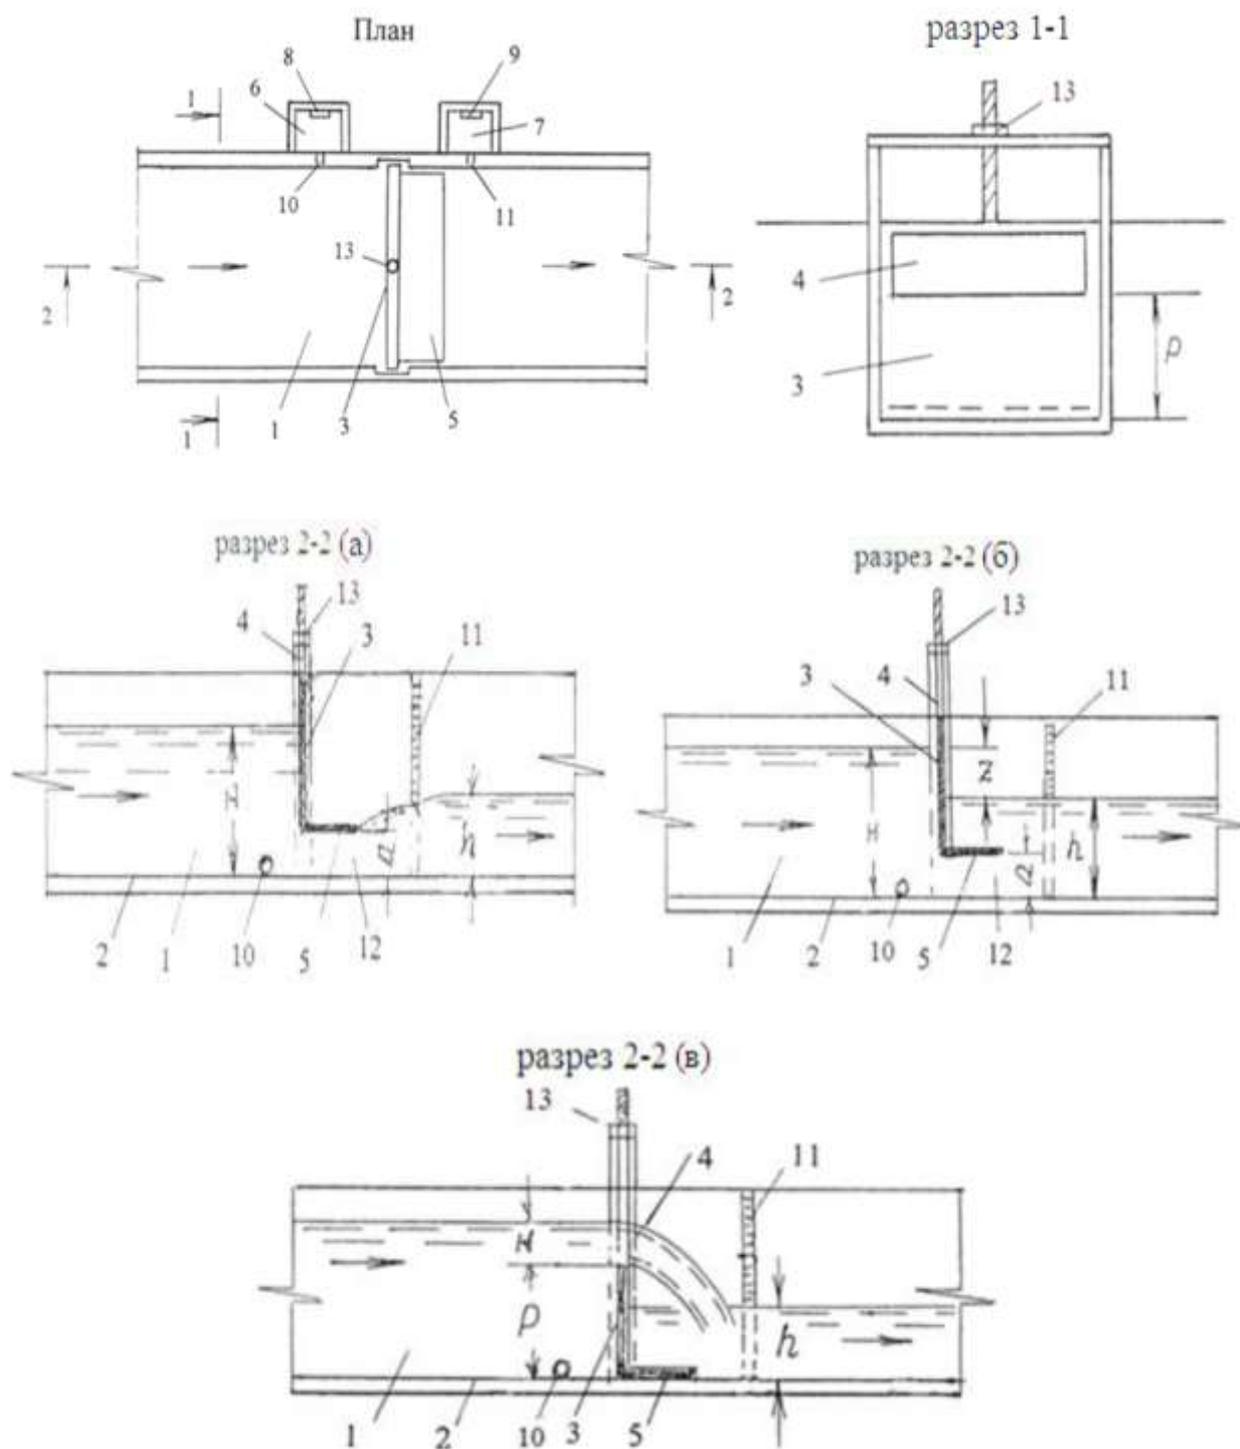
Схема комбинированного водомера типа «Водослив-прямоугольный насадок» применительно к водотокам прямоугольного сечения.
